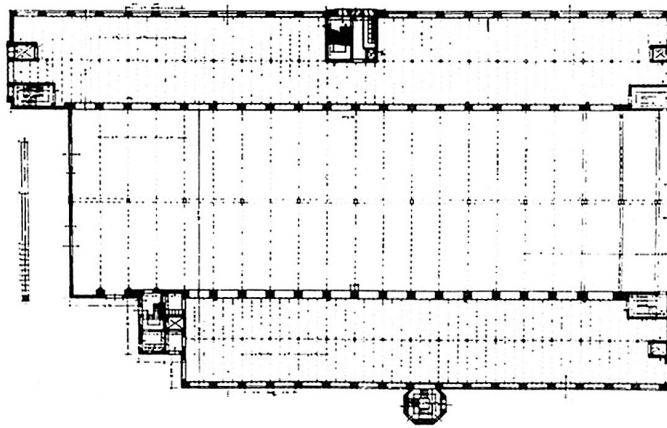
P. Behrens, *AEG-Hochspannungsfabrik*, Grundriss EG
